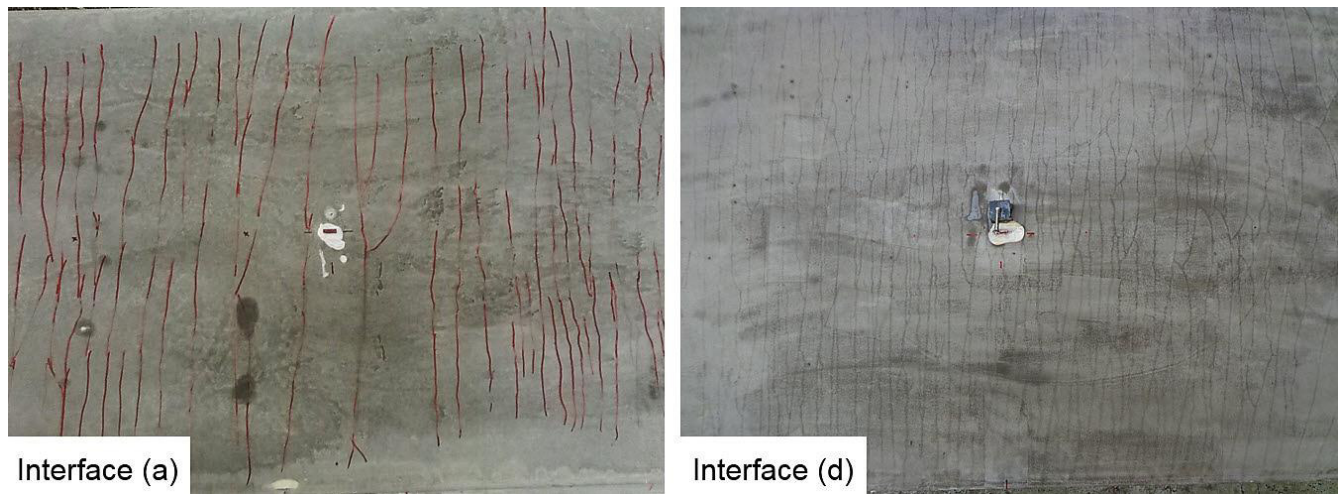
Faciès de la multi-fissuration de la couche minérale inférieure de la configuration BD800_20 avec l'interface (a) et l'interface (d).
